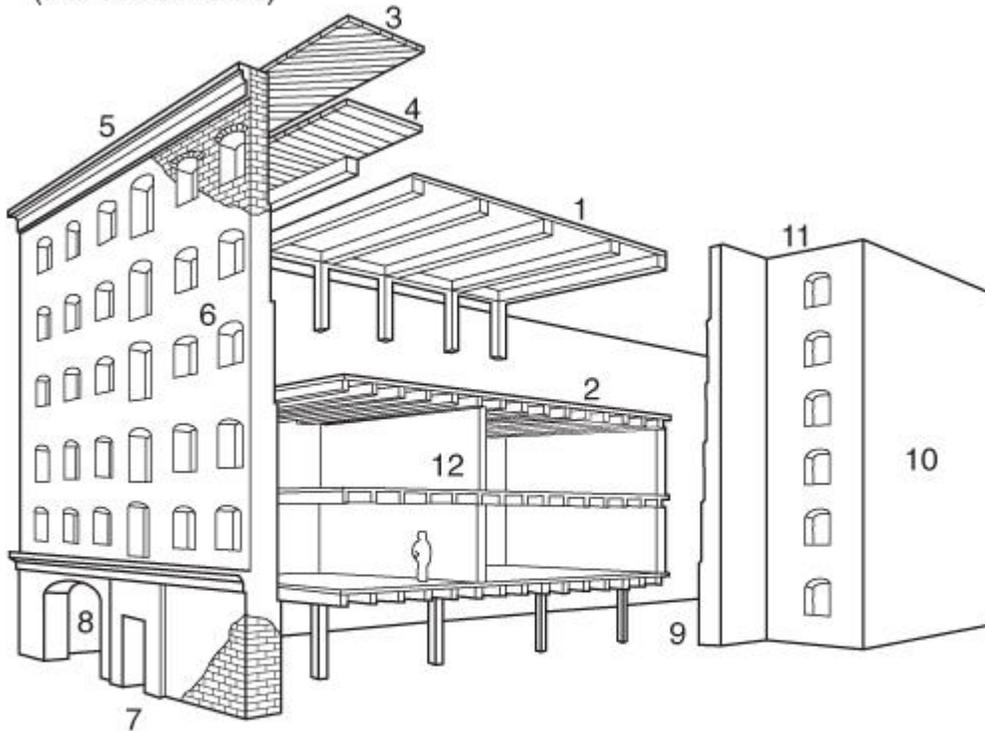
(n) sin refuerzo muro de mampostería, el Ejemplo 3 de 3 de cojinete.
